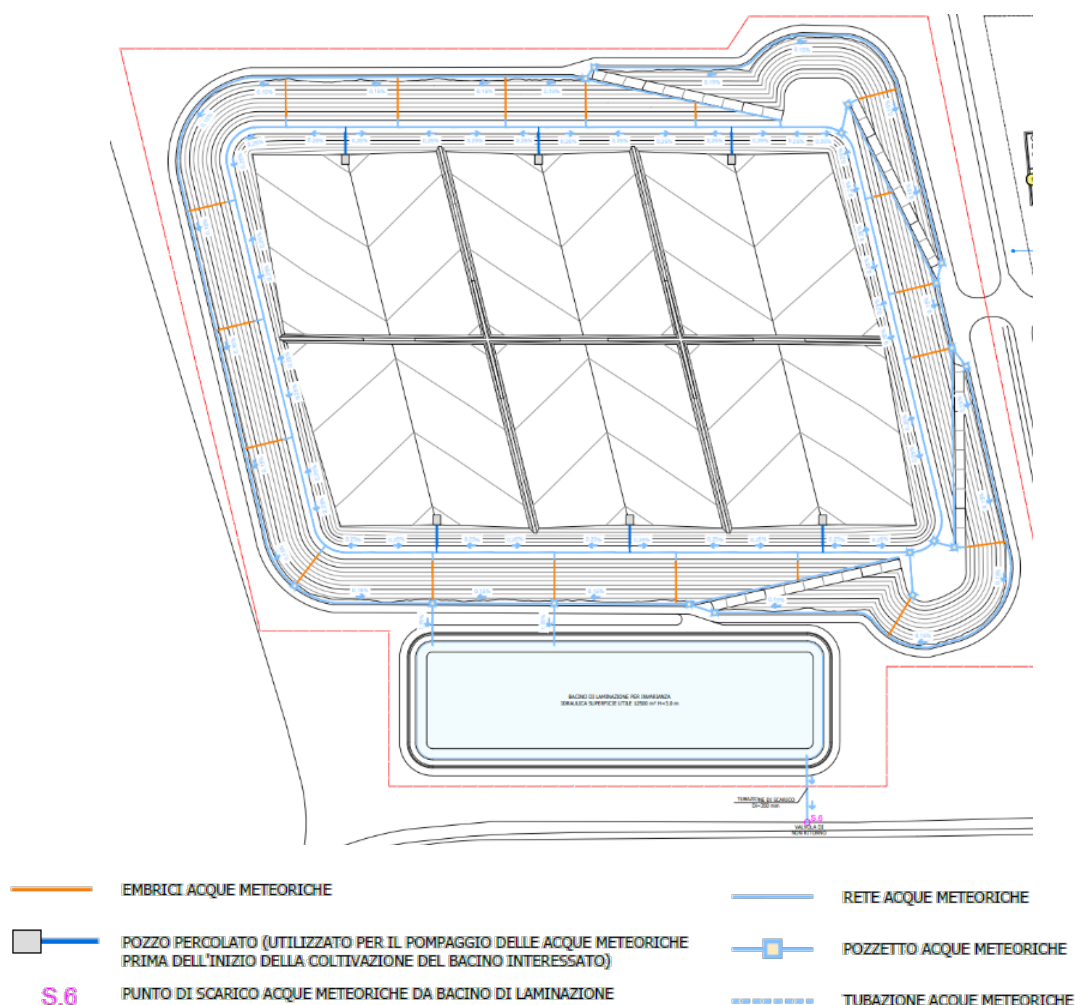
Planimetria rappresentante la gestione delle acque meteoriche - fase iniziale
